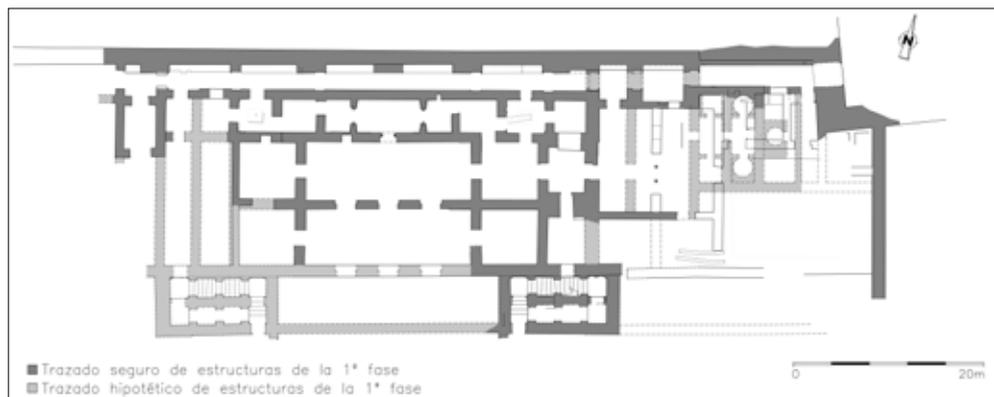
Planta de la 1ª fase constructiva de la *Dar al-Mulk*.
